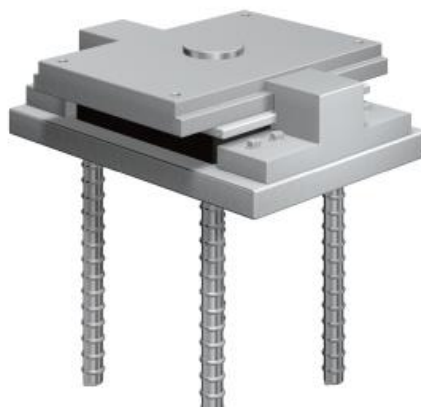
Exemplo de AA deslizante (Rubber Bearing)
